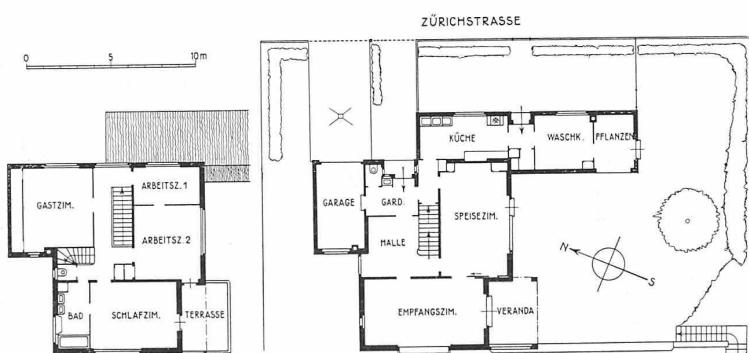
Grundrisse 1 : 400 zum Hause Schäfer in Küsnacht bei Zürich.
